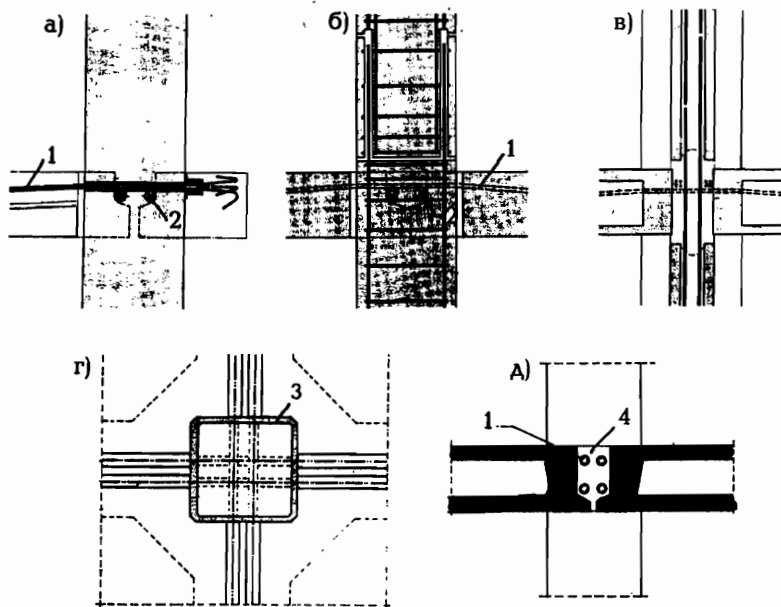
Схемы размещения напрягаемой арматуры в элементах каркаса: а - узел сопряжения колонн, плит перекрытия и бортовых балок; б, в - стыки колонн и размещение напрягаемой арматуры; г - узел сопряжения панелей перекрытия и колонн; д - схема размещения напрягаемой арматуры в стыках плит перекрытия; 1 - поперечная напрягаемая арматура; 2 - продольная; 3 - участок омоноличивания колонн с плитами перекрытия; 4 - монолитный участок сопряжения плит перекрытия
